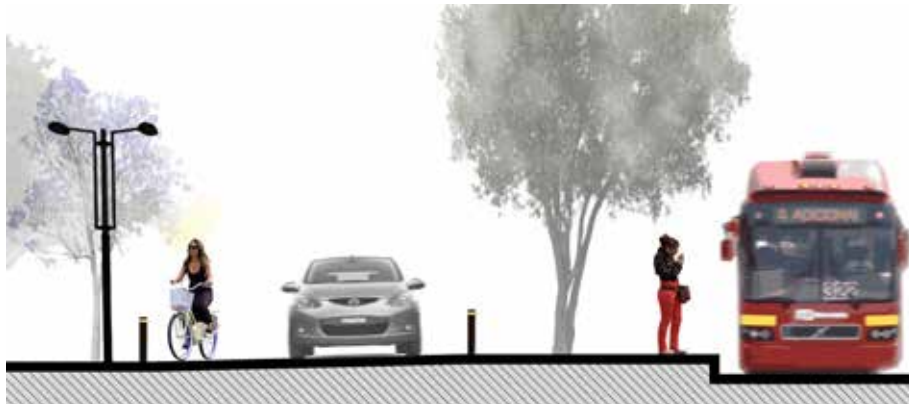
Corte transversal, propuesta de cruce a nivel en parada de Metrobús. Elaboración propia
